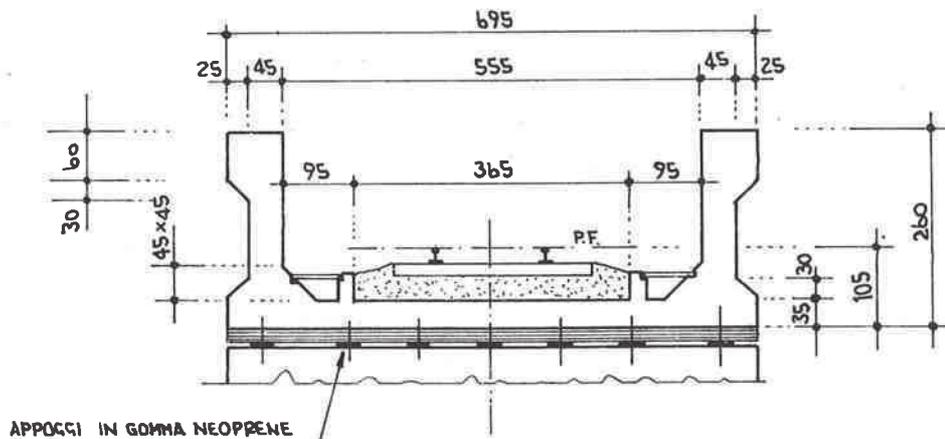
Sezione trasversale tipica di un ponte in c.a. precompresso a via inferiore.
